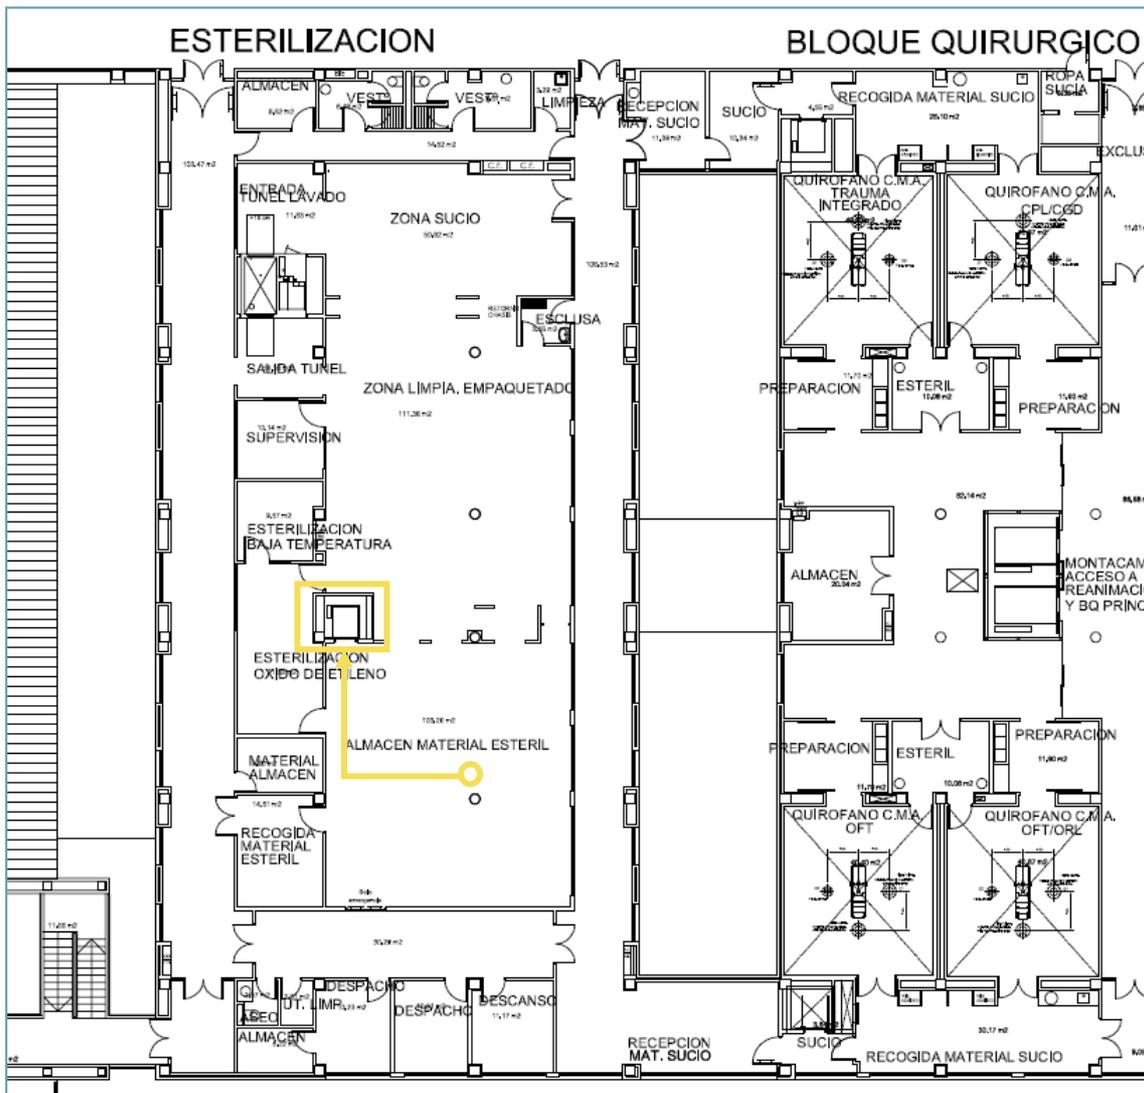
Plano esquemático de la zona limpia del servicio de esterilización.
